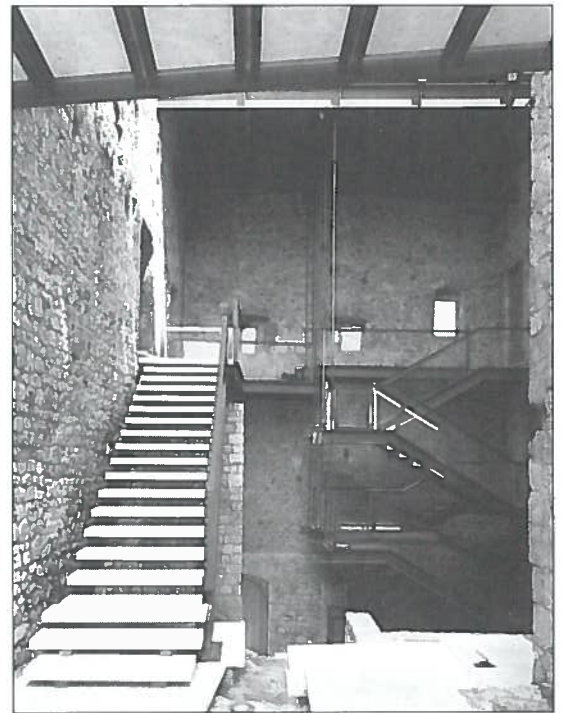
Restauro di Castello Caetani a Trevi. Vista della corte con la scala coperta a sospensione diretta sullo sfondo e la scala esterna a rampa rettilinea in primo piano.
